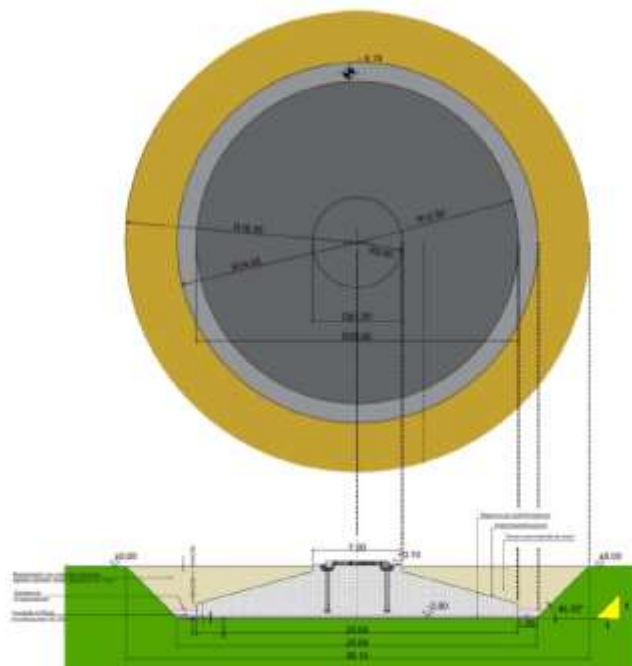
Pianta e vista della fondazione tipo dell'aerogeneratore
